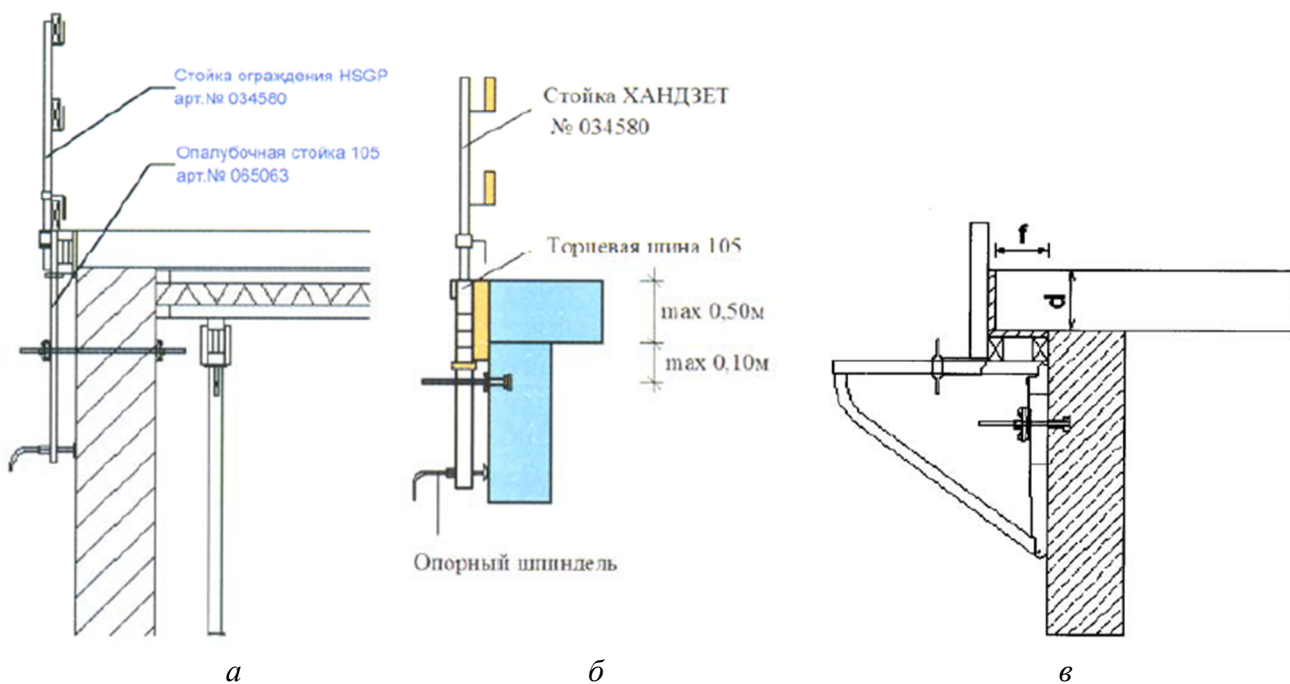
Варианты крепления торцевой опалубки: а – крепление опалубки и ограждения к существующей стене через сквозное отверстие; б – анкерное крепление опалубки к стене; в – консольное крепление опалубки
